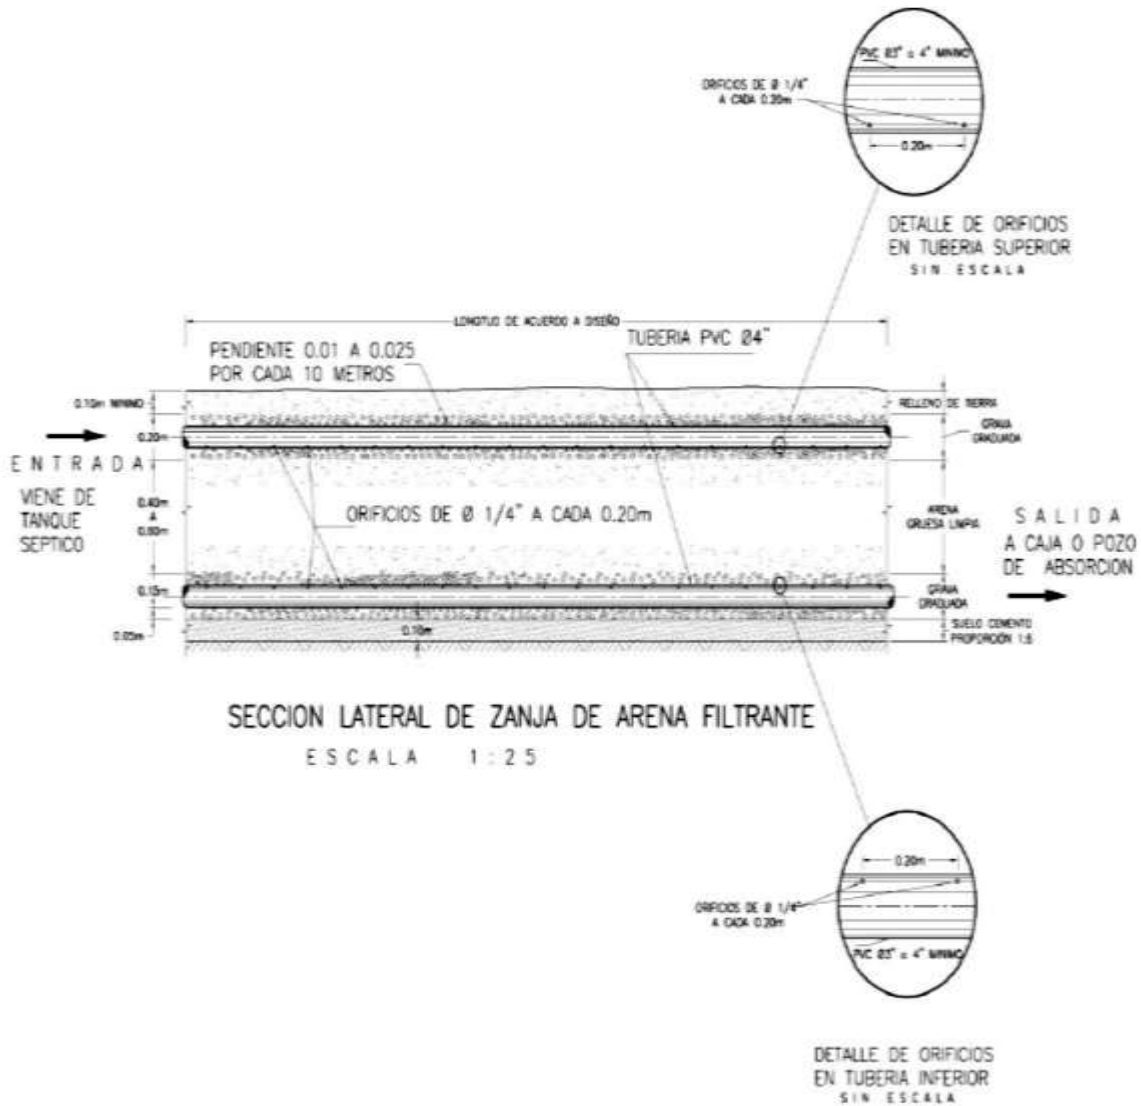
Esquema de sección lateral de Zanja de arena filtrante (MINSAL, 2009).
